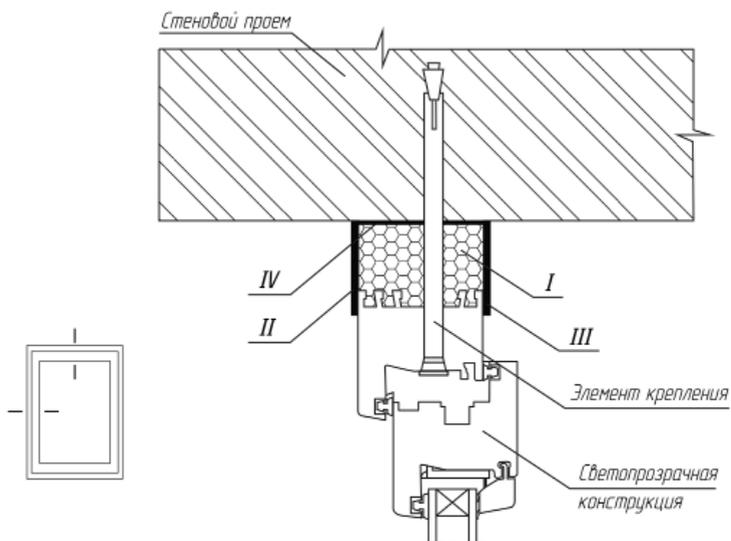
Схема монтажного шва узла примыкания оконного блока к стеновому проему без четверти
